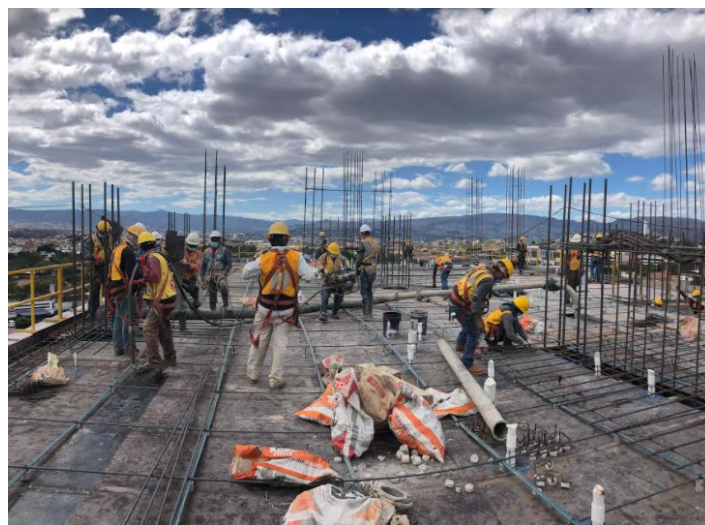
Colado de últimos elementos estructurales en losa N-08
